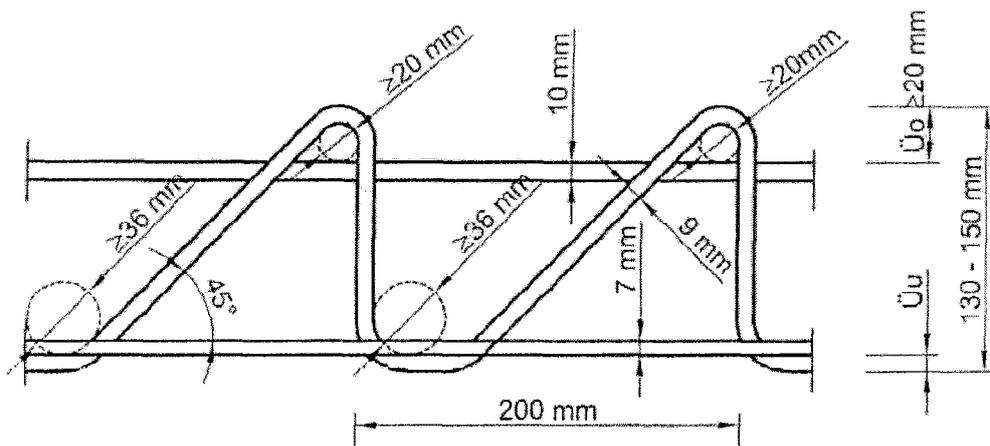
Ansicht FILIGRAN - Durchstanzbewehrung (h ≤ 150 mm)
